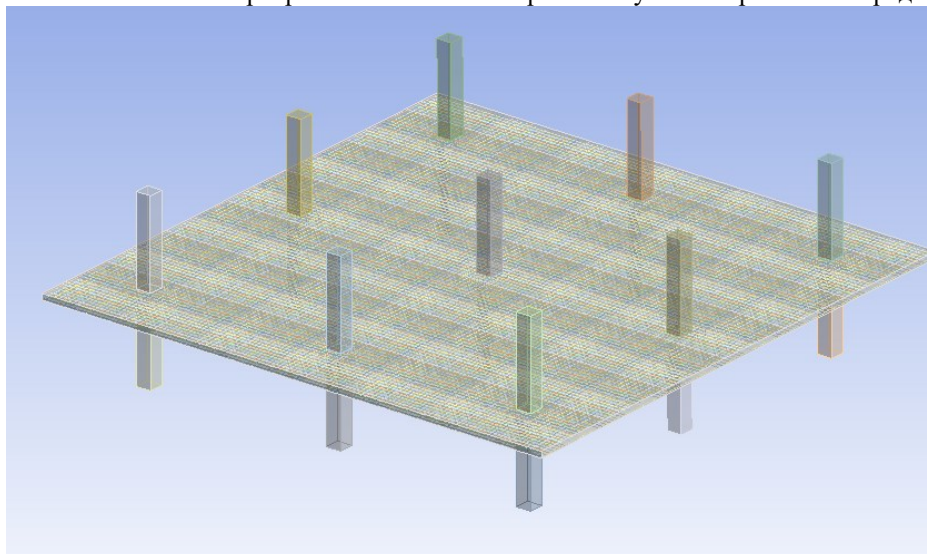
Расчетная схема безбалочного монолитного перекрытия в расчетной среде Ansys
